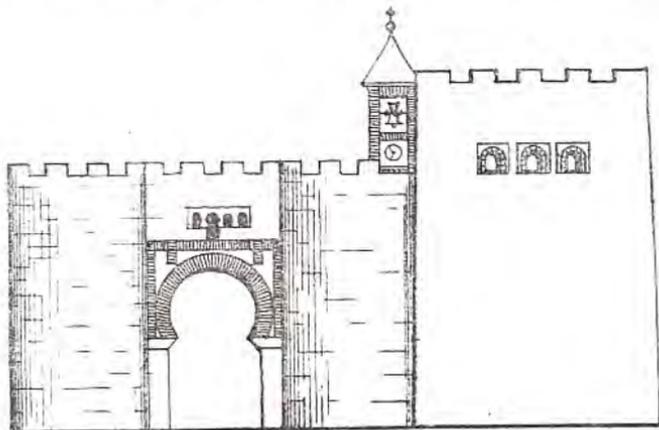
Alzado exterior de la Puerta Vieja de Guadalajara (1538, año del derribo).
